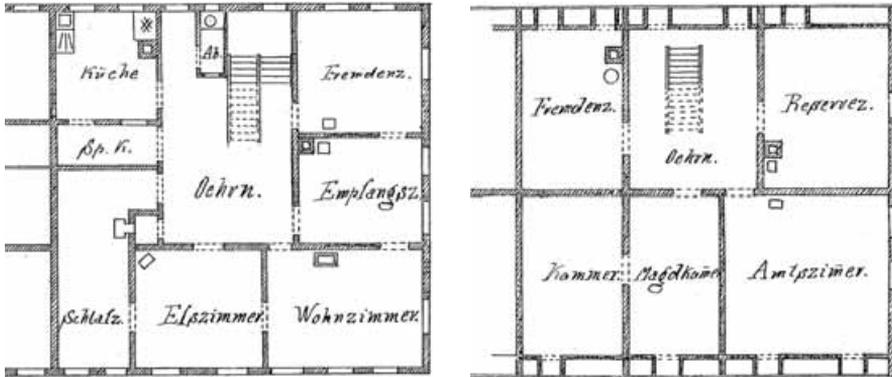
Aulberstraße 1, Planbeilage zur Erweiterung der Baubeschreibung im Jahr 1888 nach dem Umbau von 1887, Grundrisse Obergeschoss und 1. Dachgeschoss, östliche Haushälfte.
